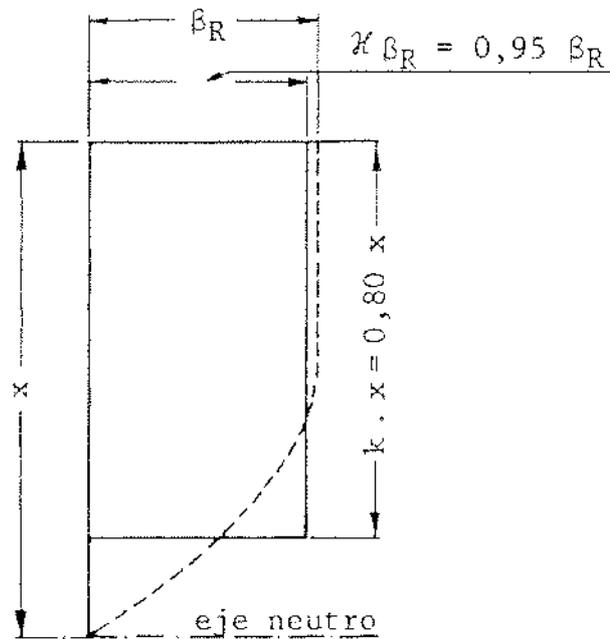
Distribución de tensiones, como auxiliar del diagrama parabólico rectangular, para el dimensionamiento simplificado de secciones complicadas, para las cuales no hay tablas de dimensionamiento.
